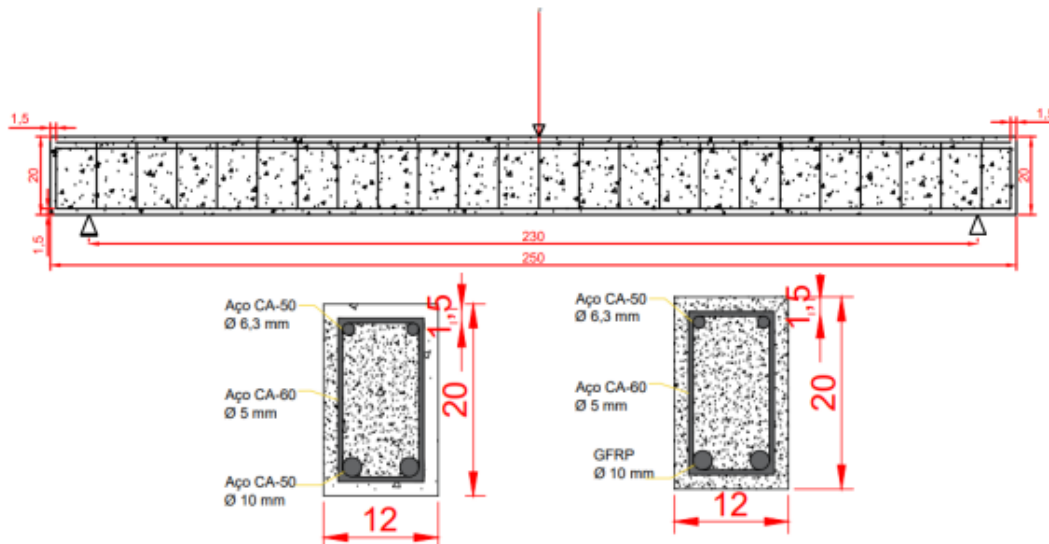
Configuração da viga de estudo. Fonte: Adaptado de Dalfré, Mazzú e Ferreira (2021)
